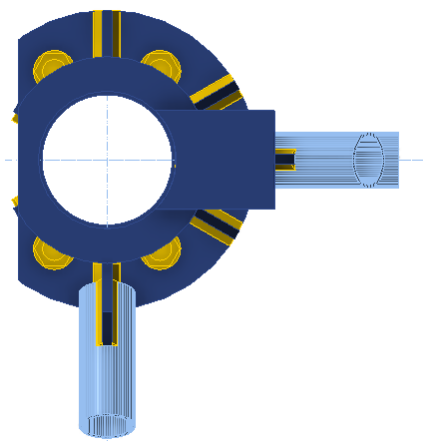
Розріз монтажного стику верхнього поясу просторового блоку ферми
